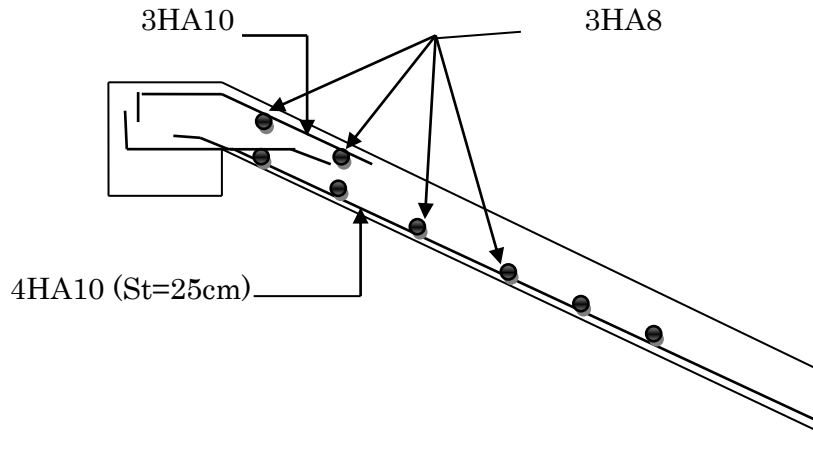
Schéma de ferrailage d'escalier type 1
